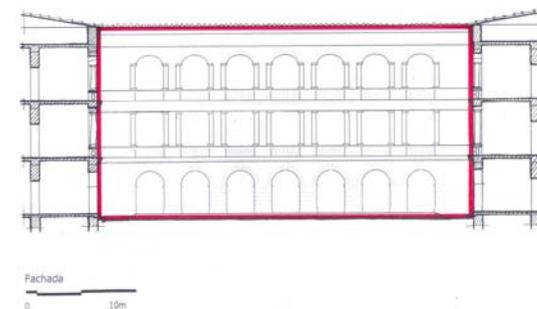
Estudo de proporção do pátio interno do ISERJ, vista da fachada Sudeste (Fonte: O AUTOR,2006).
